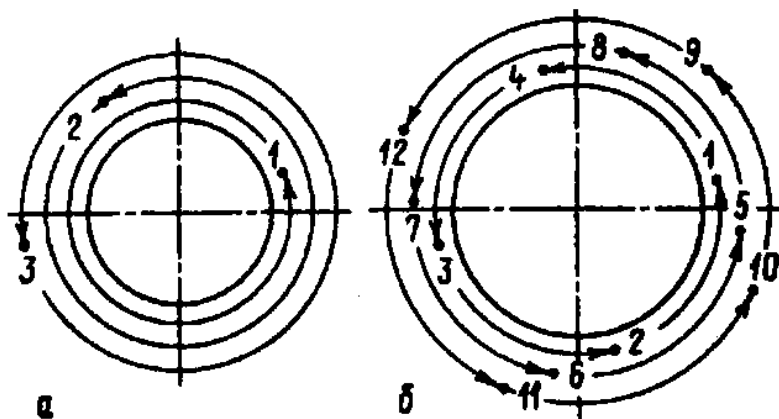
Порядок наложения слоев (валиков) при сварке одним сварщиком горизонтальных стыков труб:
